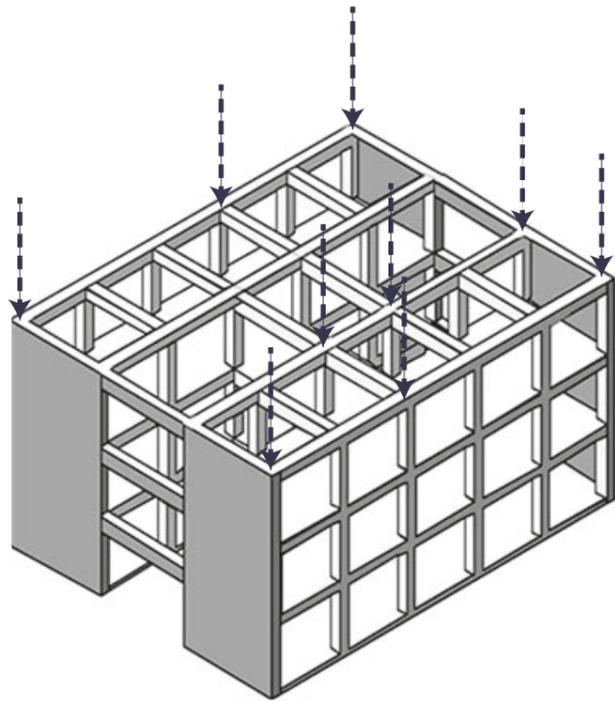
Trasmisión de cargas en un sistema estructural de pórtico.
